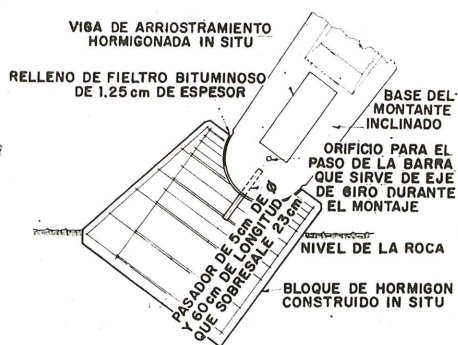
Detalle del enlace entre el montante y el bloque de cimentación.
